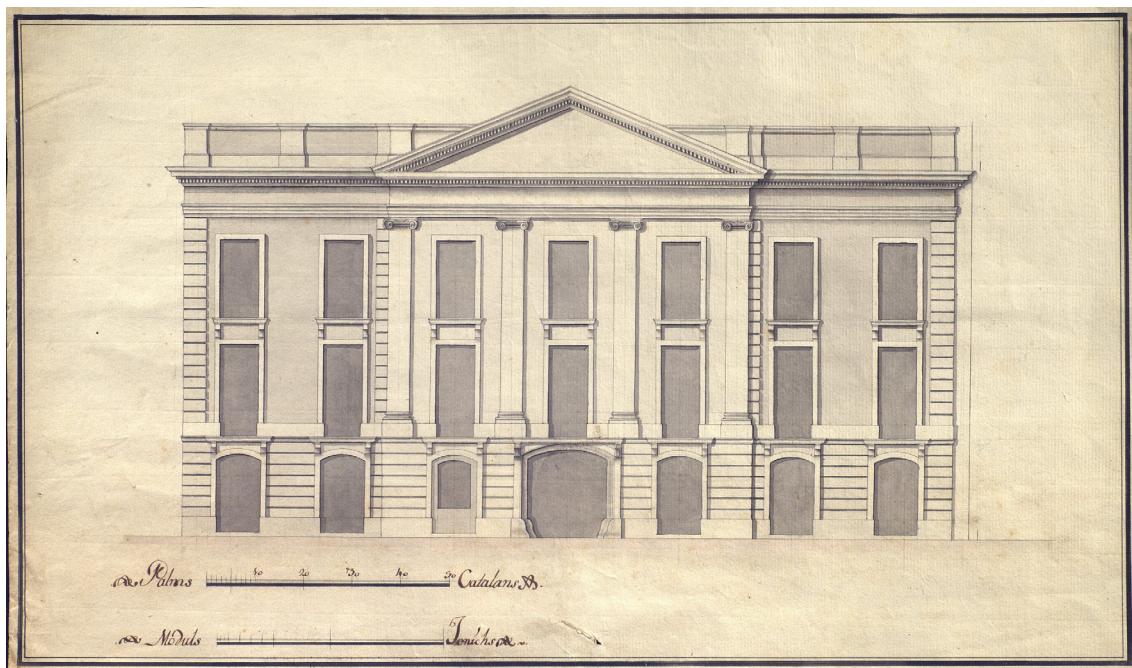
Alzado de la fachada del *segundo* proyecto de reforma de la Casa Dou. AHCB.
